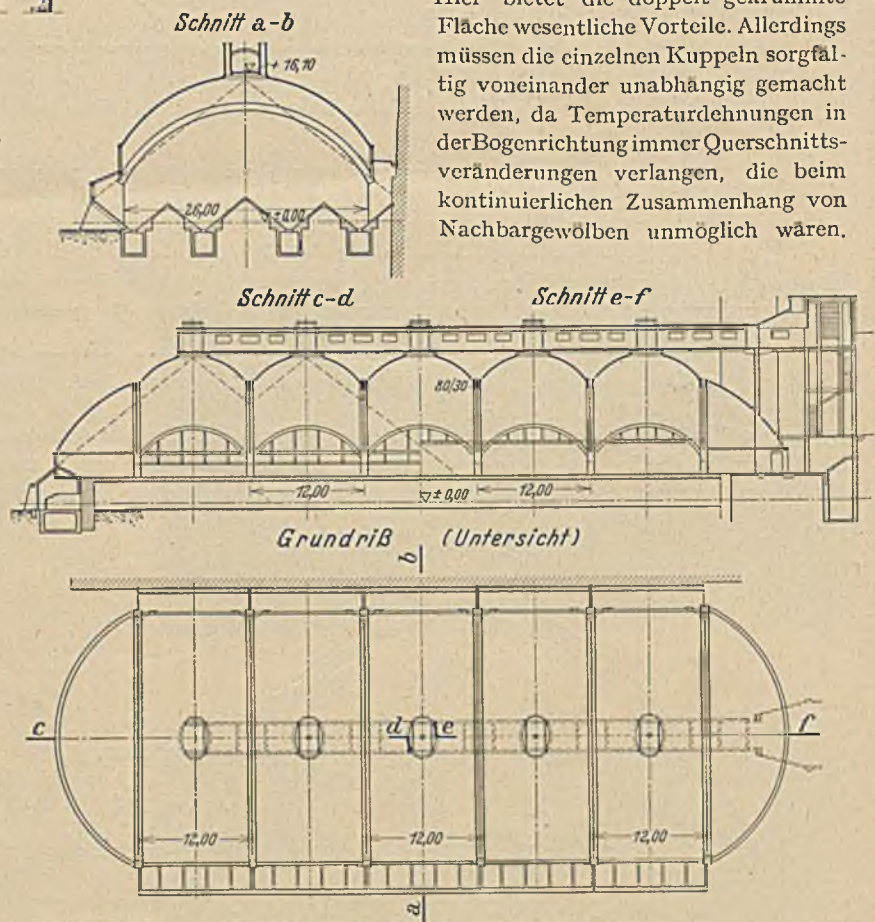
Klinkerhalle Beocin, Grundriß und Schnitte.
